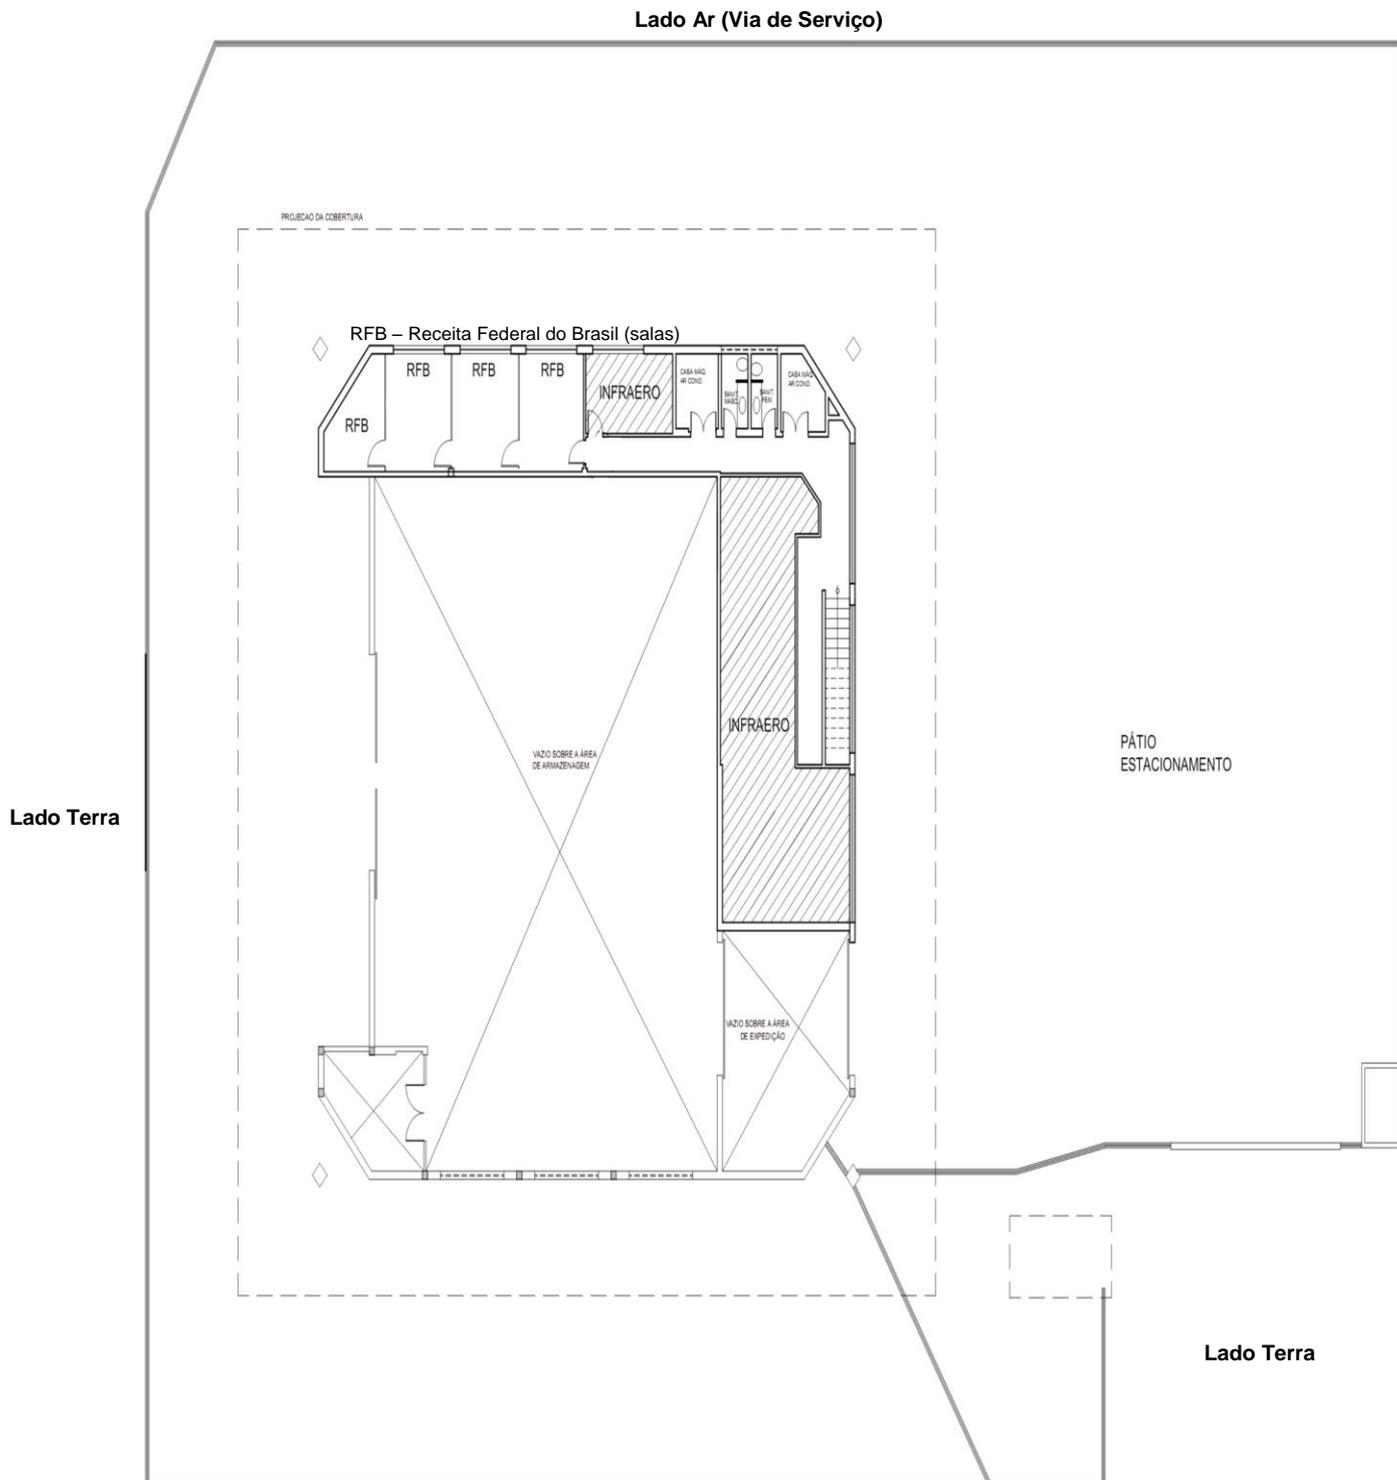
Terminal de Cargas: Planta Baixa Térreo
